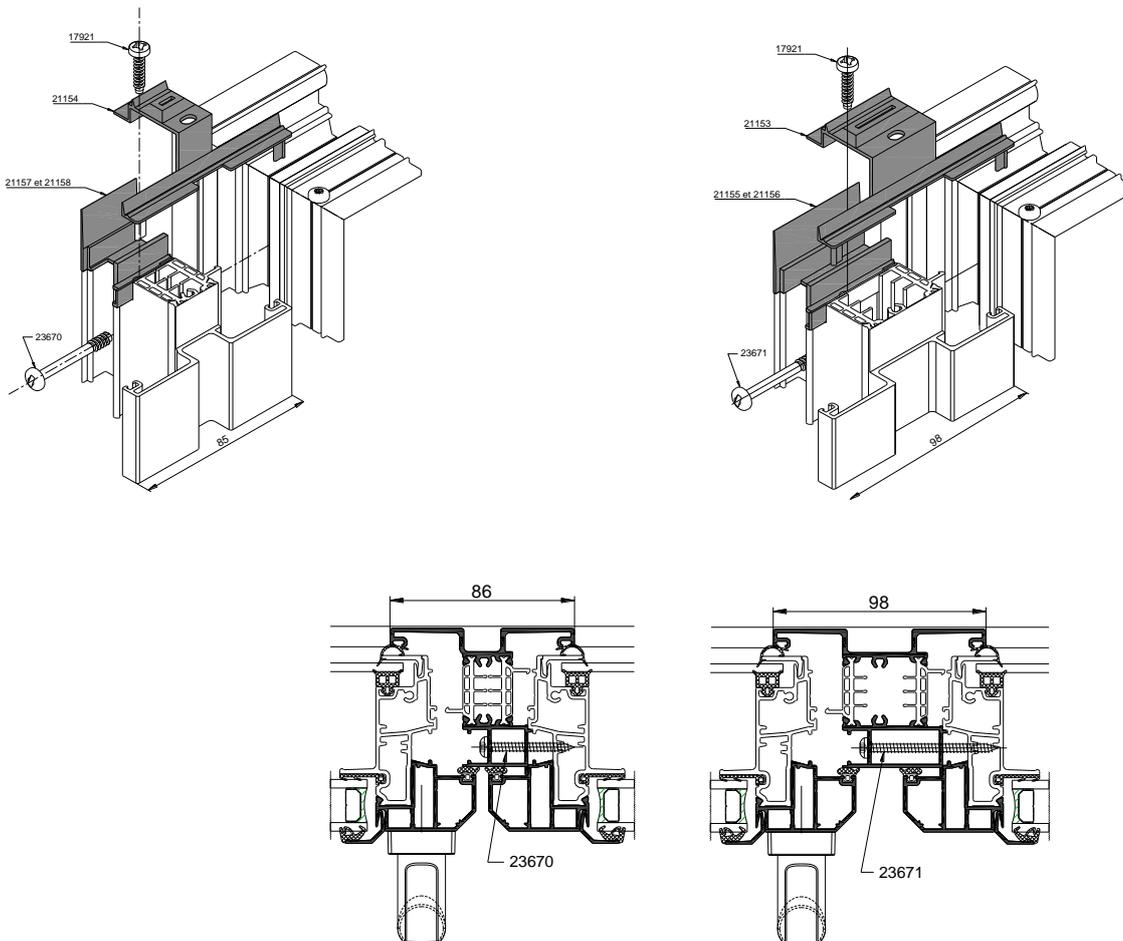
DETAIL ASSEMBLAGES TRAVERSE / MENEAU 98MM
